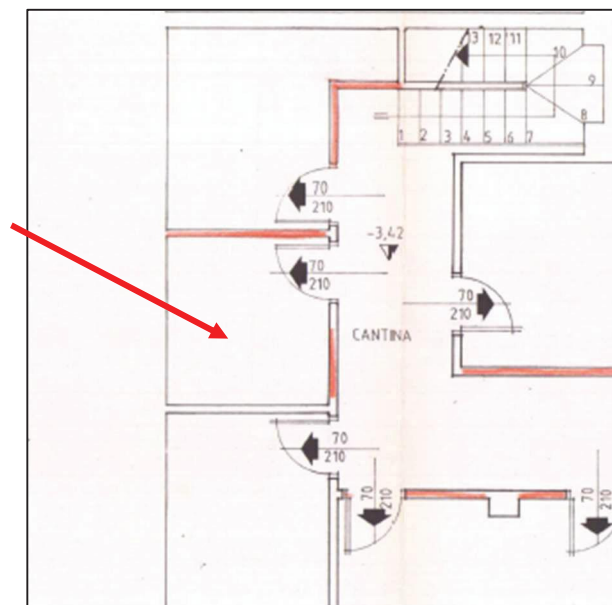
estratto tavola grafica allegata alla Concessione 2441/93
